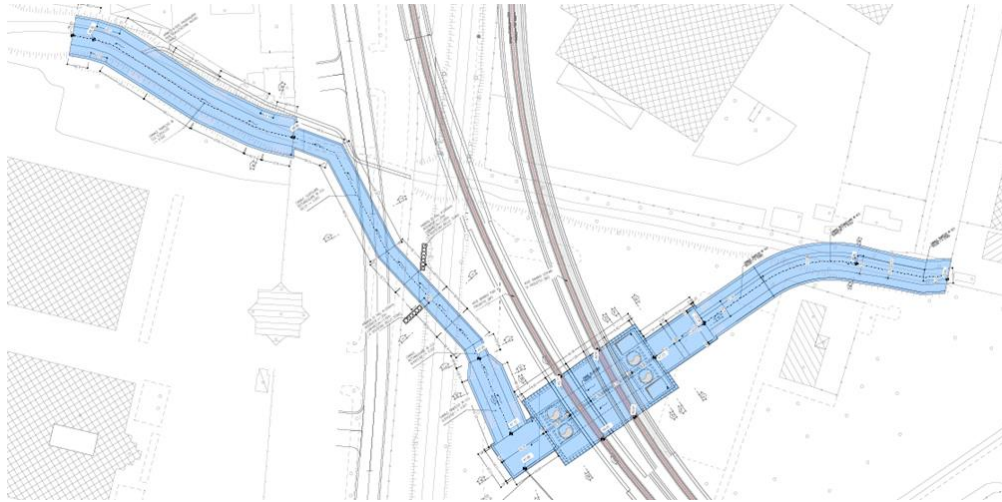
Planimetria IN01 – Sifone Abbeveratoio
